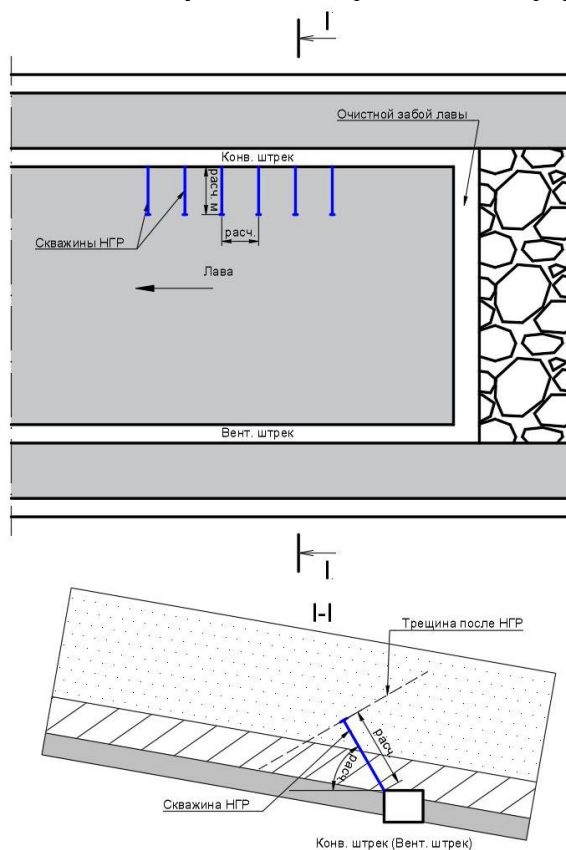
Схемы бурения скважин для проведения принудительной посадки кровли
